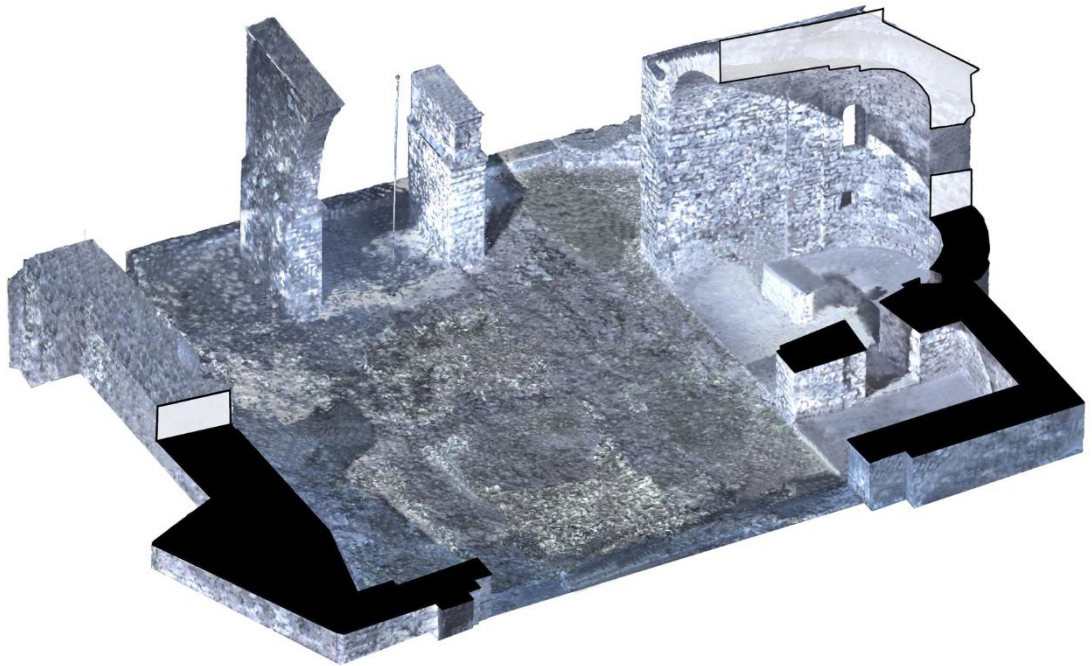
Planimetría de la Iglesia de Santa Maria de Mijaran. e.:1/200.
